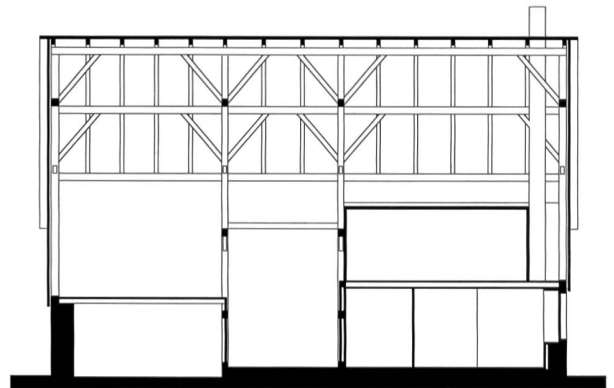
Coupe longitudinale sur le bâtiment avant transformation.
